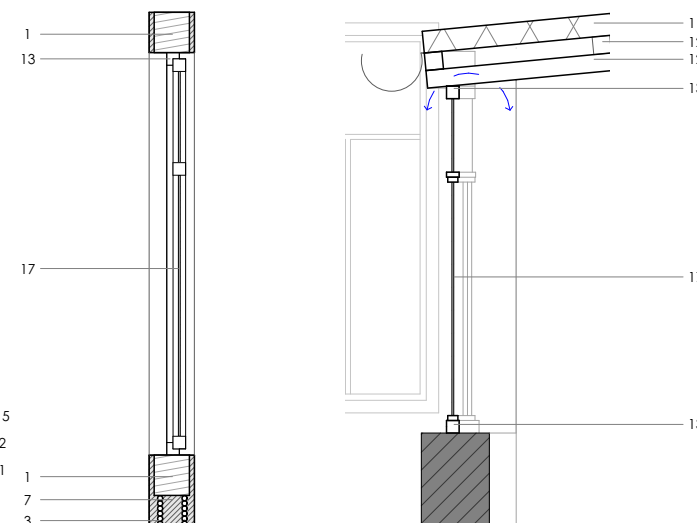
Detalle Constructivo 06. Esc. 1:50
